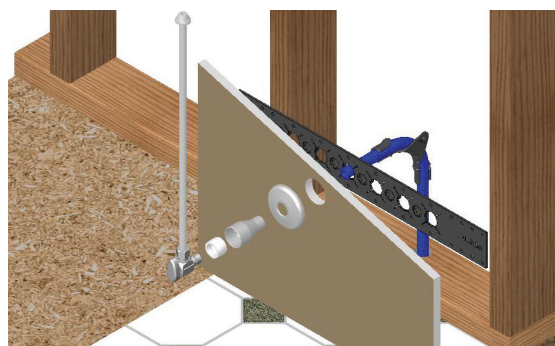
Exemple d'installation du système de support mural ProPEX
